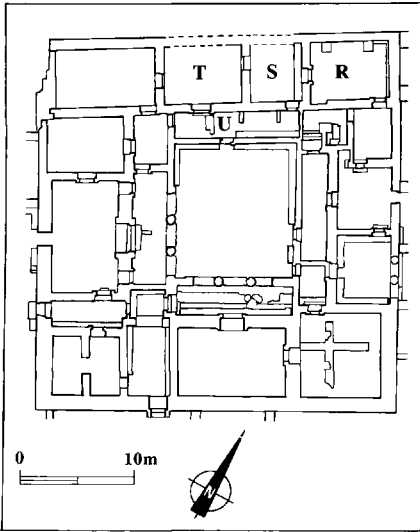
Palais du Stratège. Plan schématique du palais et localisation des pièces de la façade nord. Dessin F. Ory d'après un plan de la mission de Yale.
